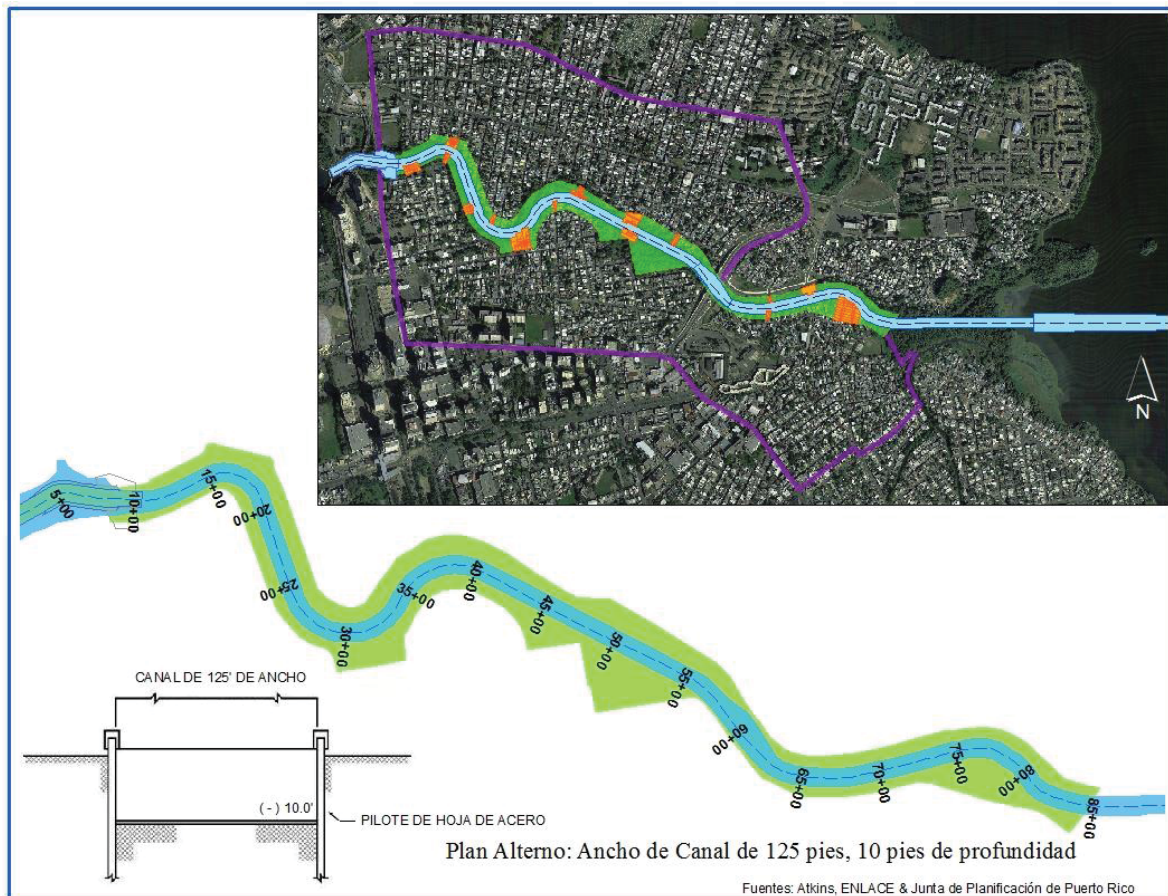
Plan Alternativo 3 – Canal de 125 pies de ancho y 10 pies de profundidad
